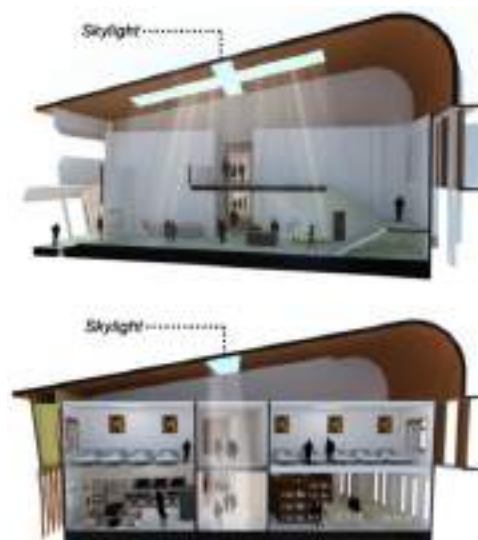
42 bentuk dan tampilan bangunan katolik center
